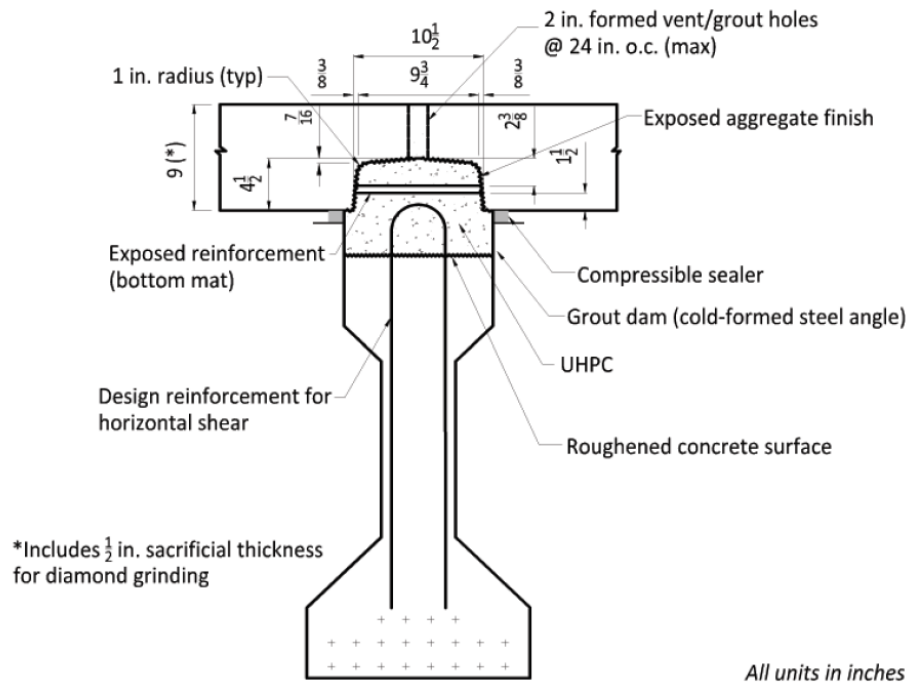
Příklad spoje s trny dle směrnice USA [103]
